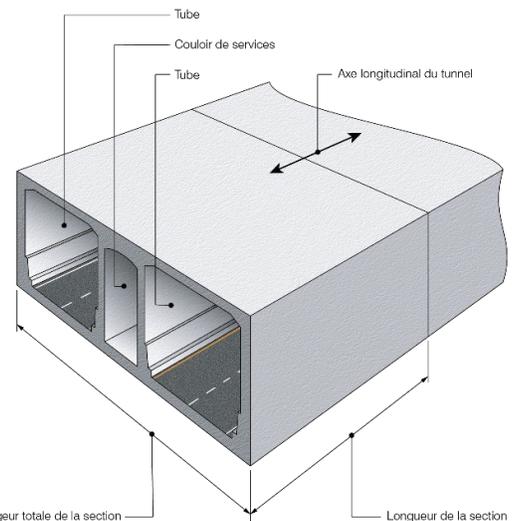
Largeur totale d'une section de tunnel constituée de plusieurs tubes
